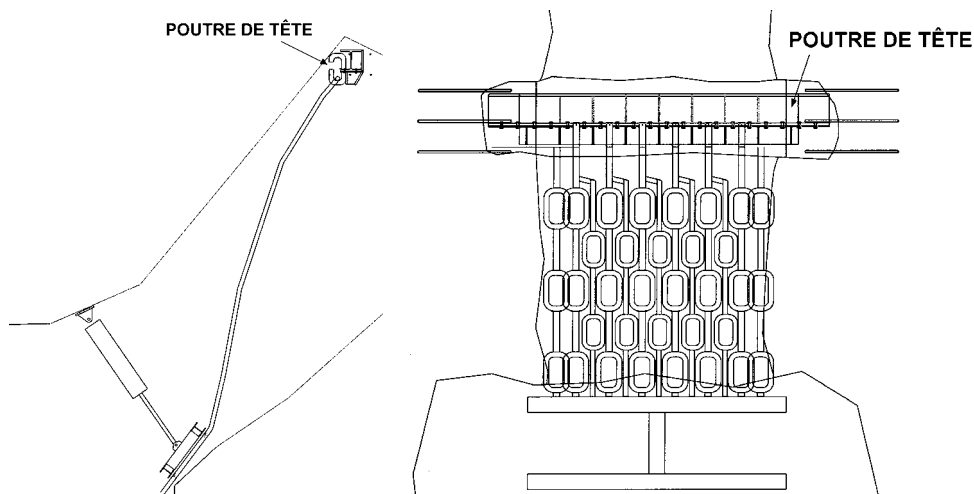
Installation des chaînes de contrôle sur une poutre de tête.
